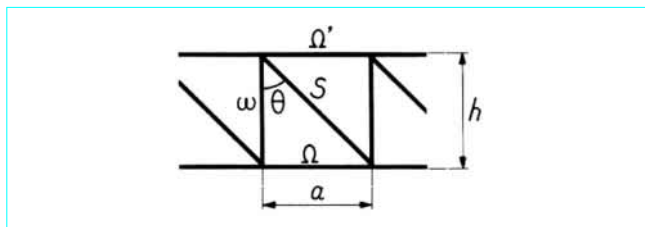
Poutre Pratt ou Howe : assimilation à une poutre en double té
